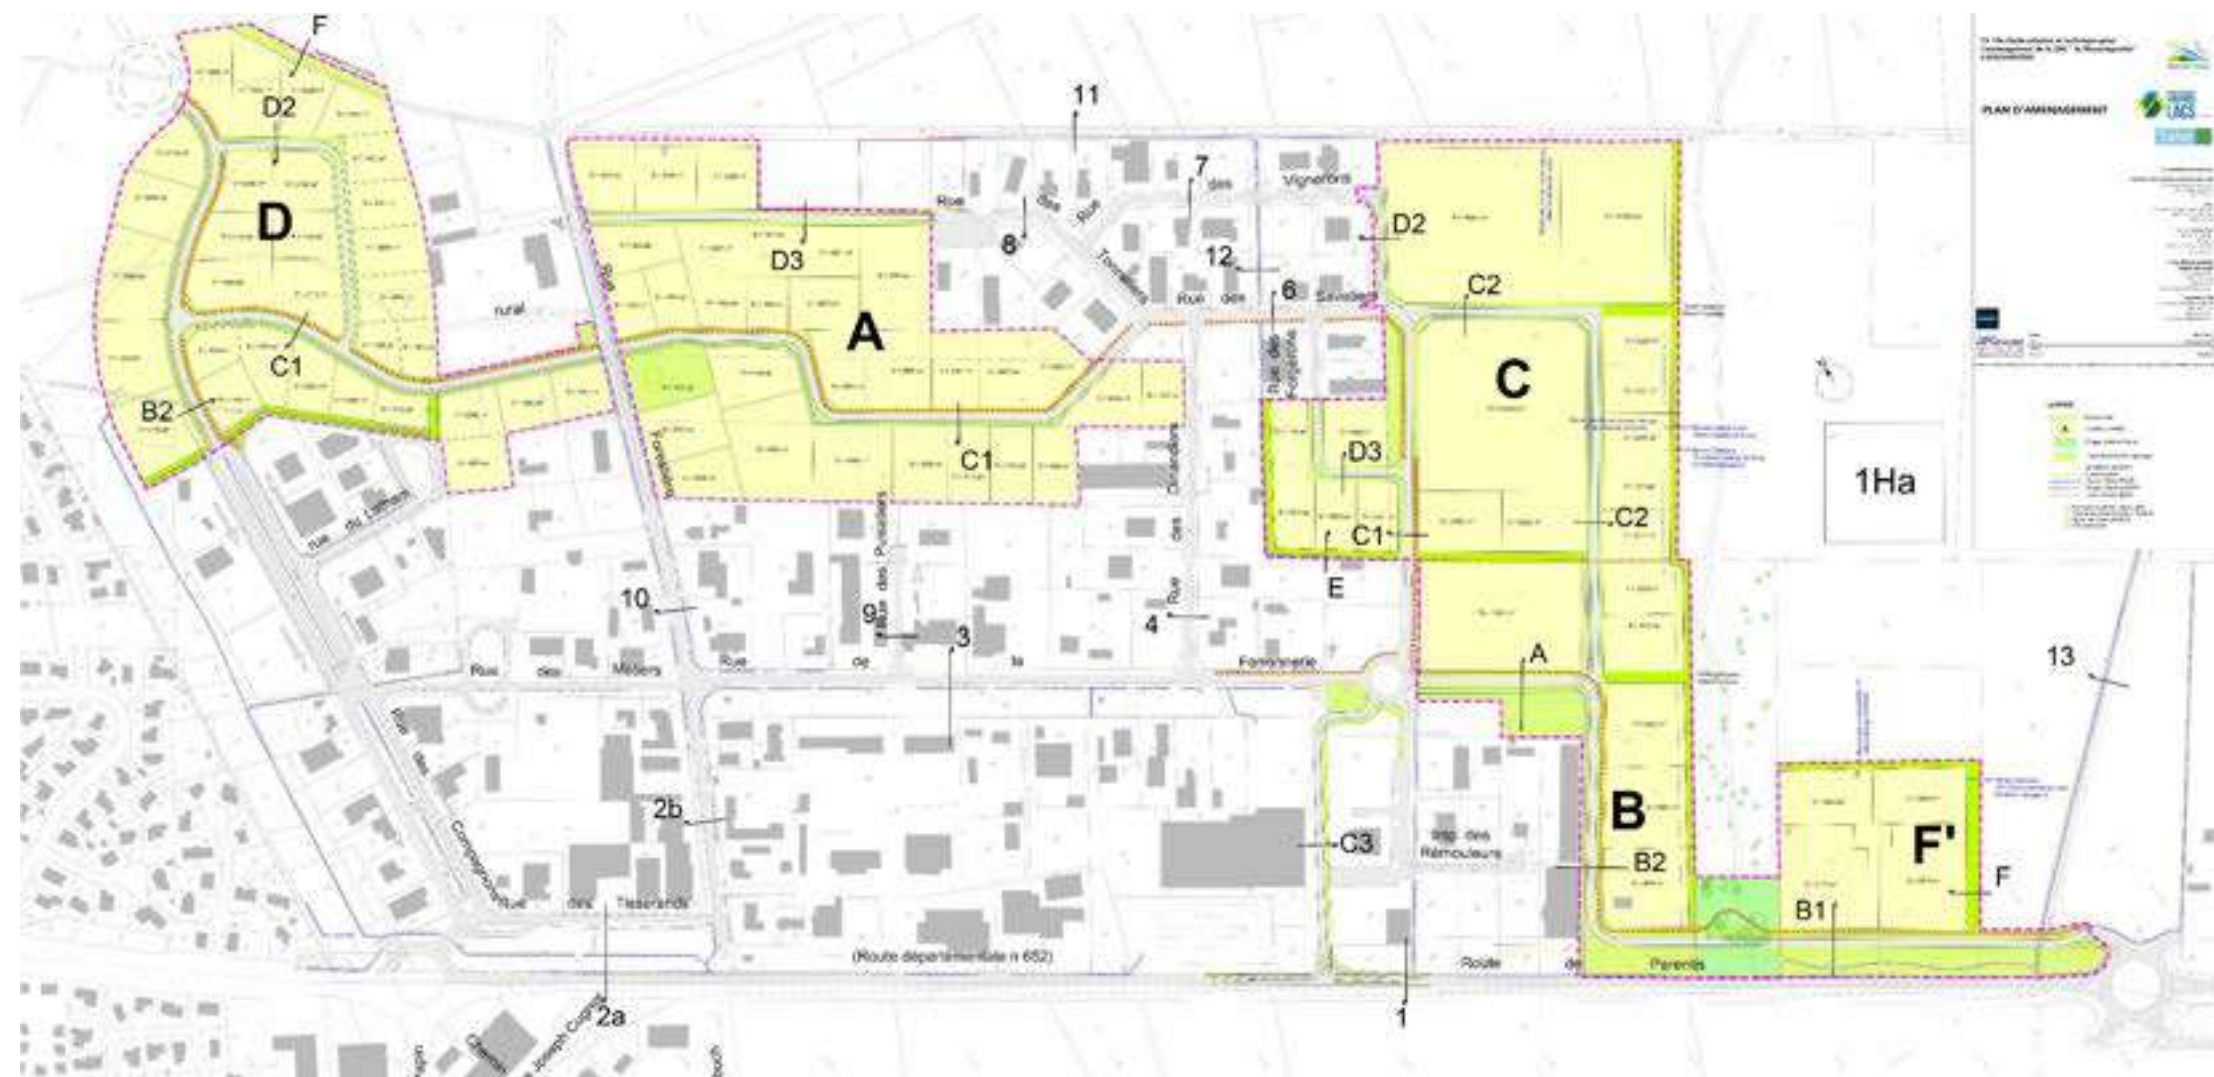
Plan d'aménagement de l'extension de la ZAC (Source: METAPHORE)
